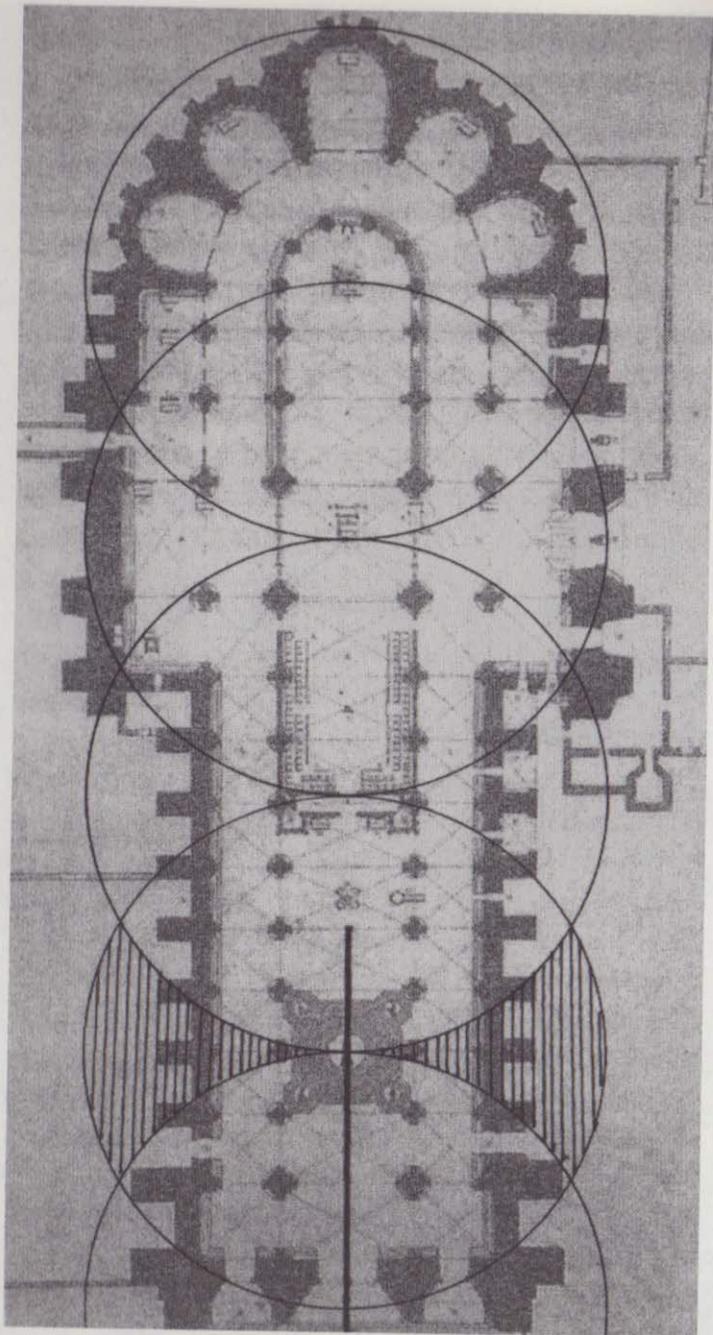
Trama geométrica circular de la planta de la catedral de Reims, sobre el plano trazado por E. Leban.
